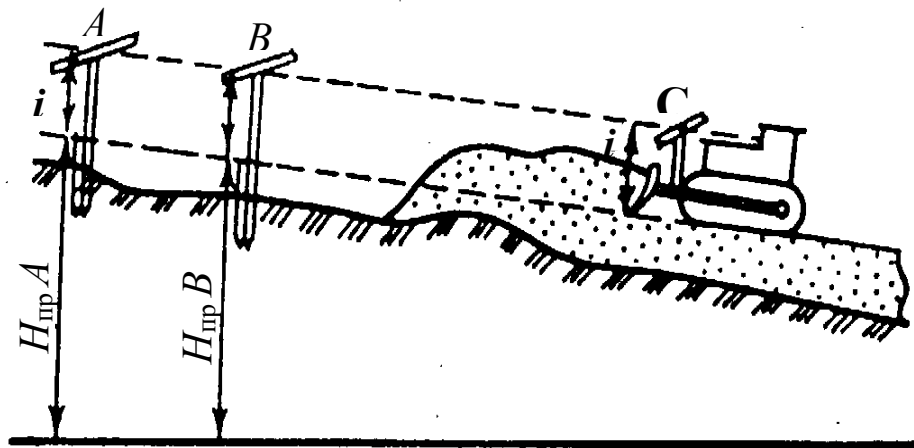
Схема планування рельєфу місцевості по візирках:
